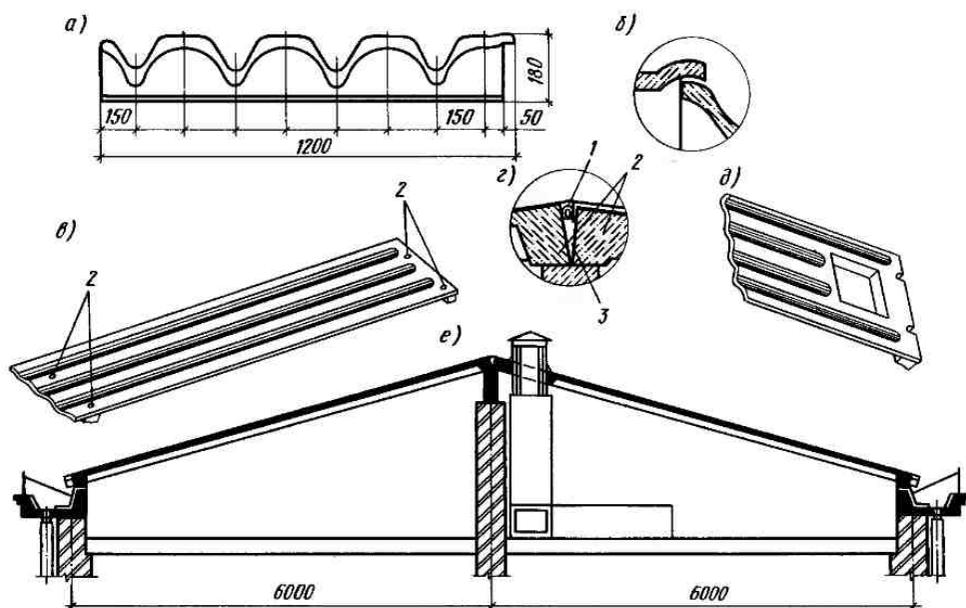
Сборная железобетонная скатная крыша из волнистых панелей:
